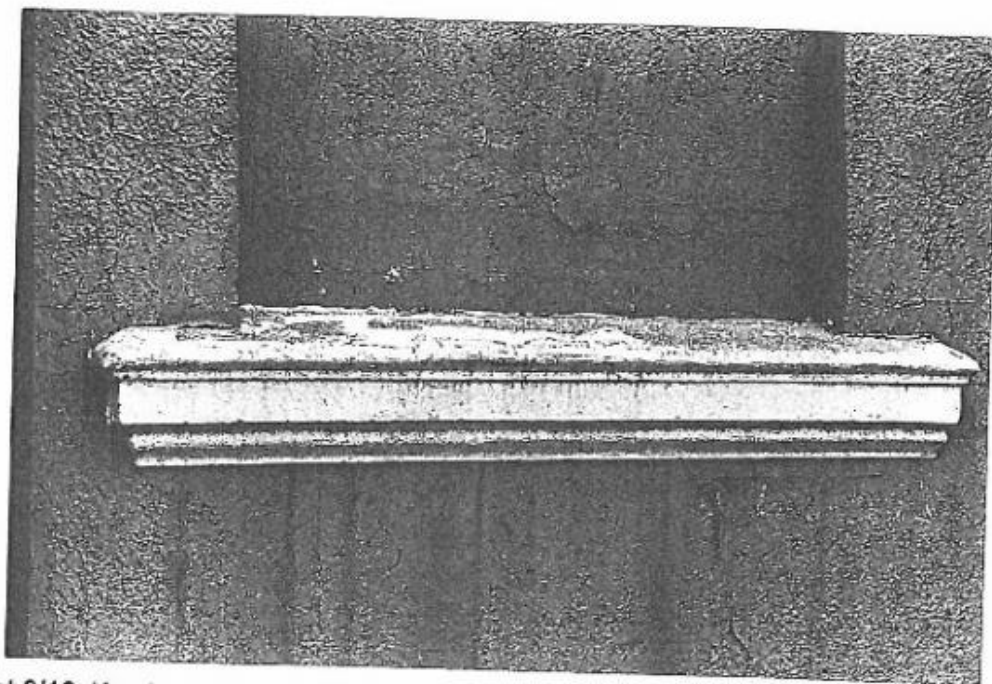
/10. Kamienica Rynek 1, elewacja wschodnia - narożnik północno-wschodni elewacji (widok od południa).
